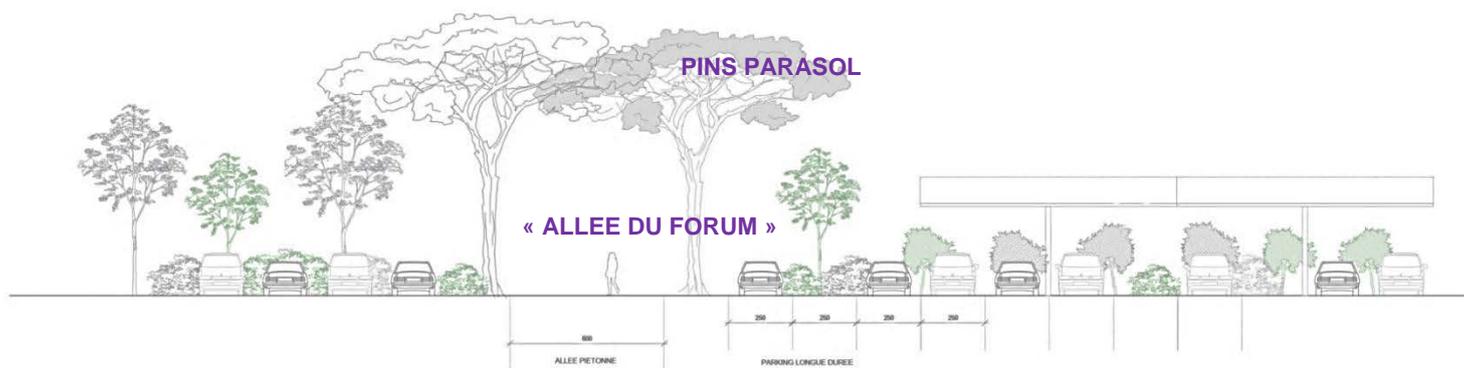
les parkings longue durée – coupe transversale sur cheminement piétons central
